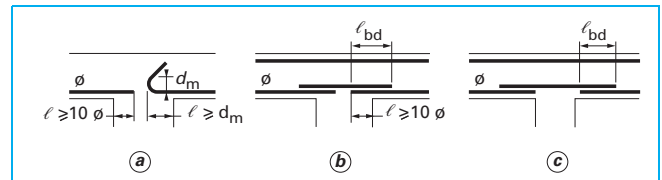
Ancrage sur un appui intermédiaire des armatures inférieures (figure 9.4 de l'EC2)
